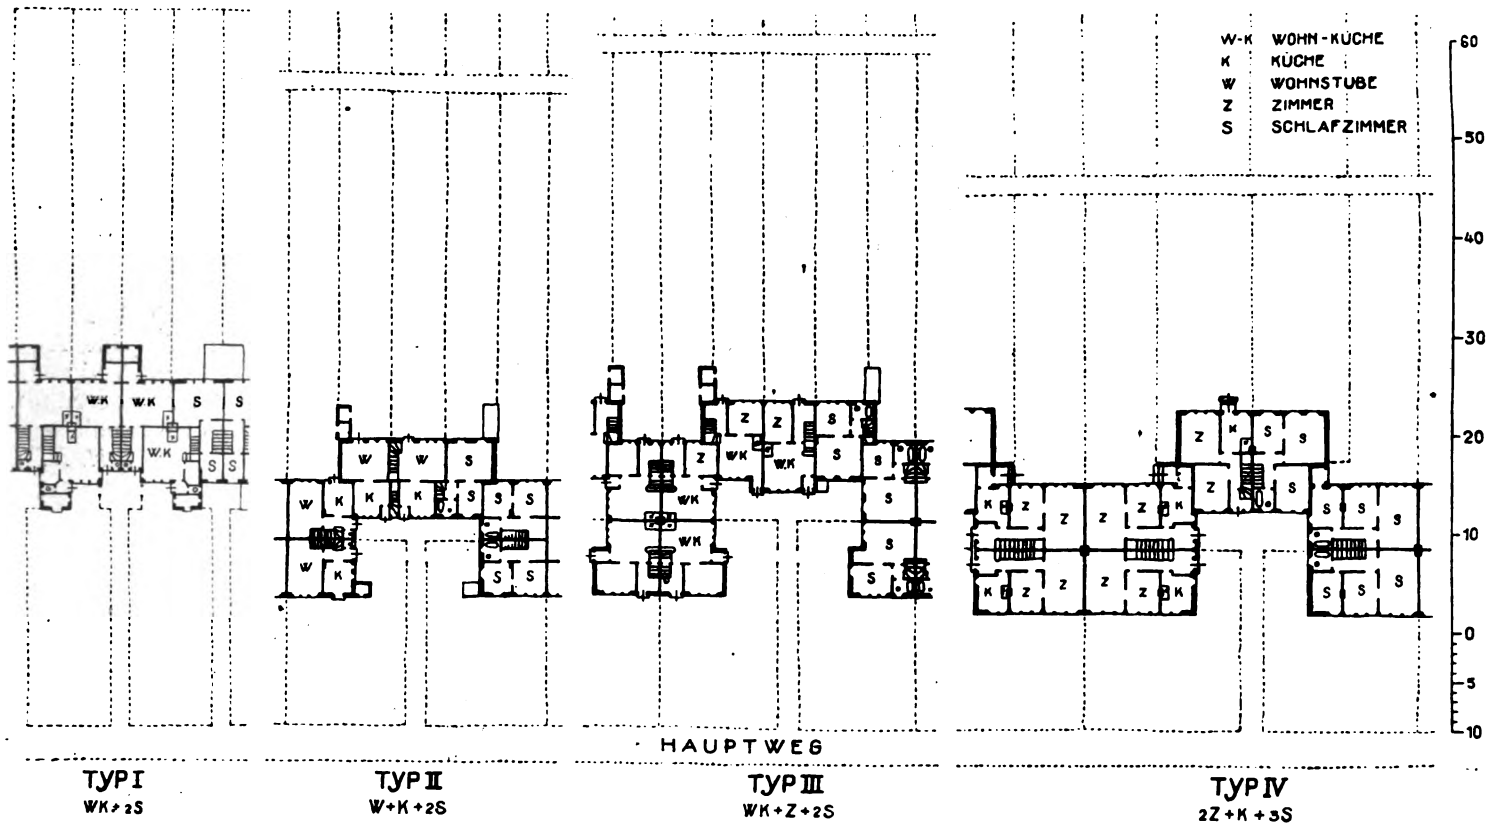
Typenskizzen für Gruppenbauweise (jeweils Erdgeschoss und Obergeschoss). Masstab 1:750. — Nach: „Vom sparsamen Bauen“, Verlag der Bauwelt, Berlin.
